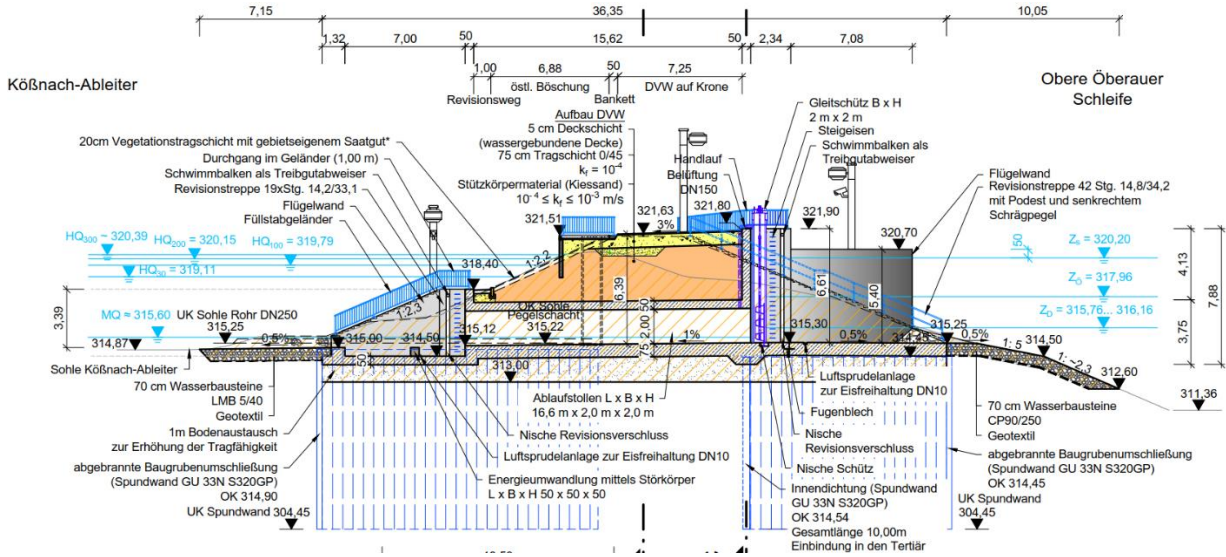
Auslaufbauwerk, Schnitt A-A (aus Plan 04-02-05, Blatt 1/2)
